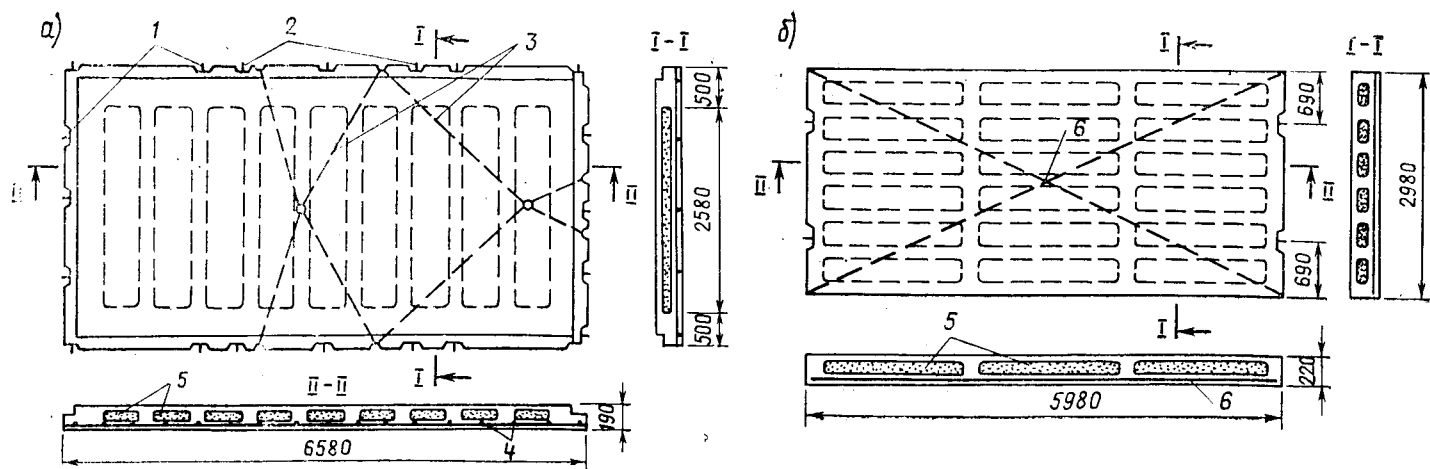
Конструкции экспериментальных плит перекрытий с заполненными пустотами
